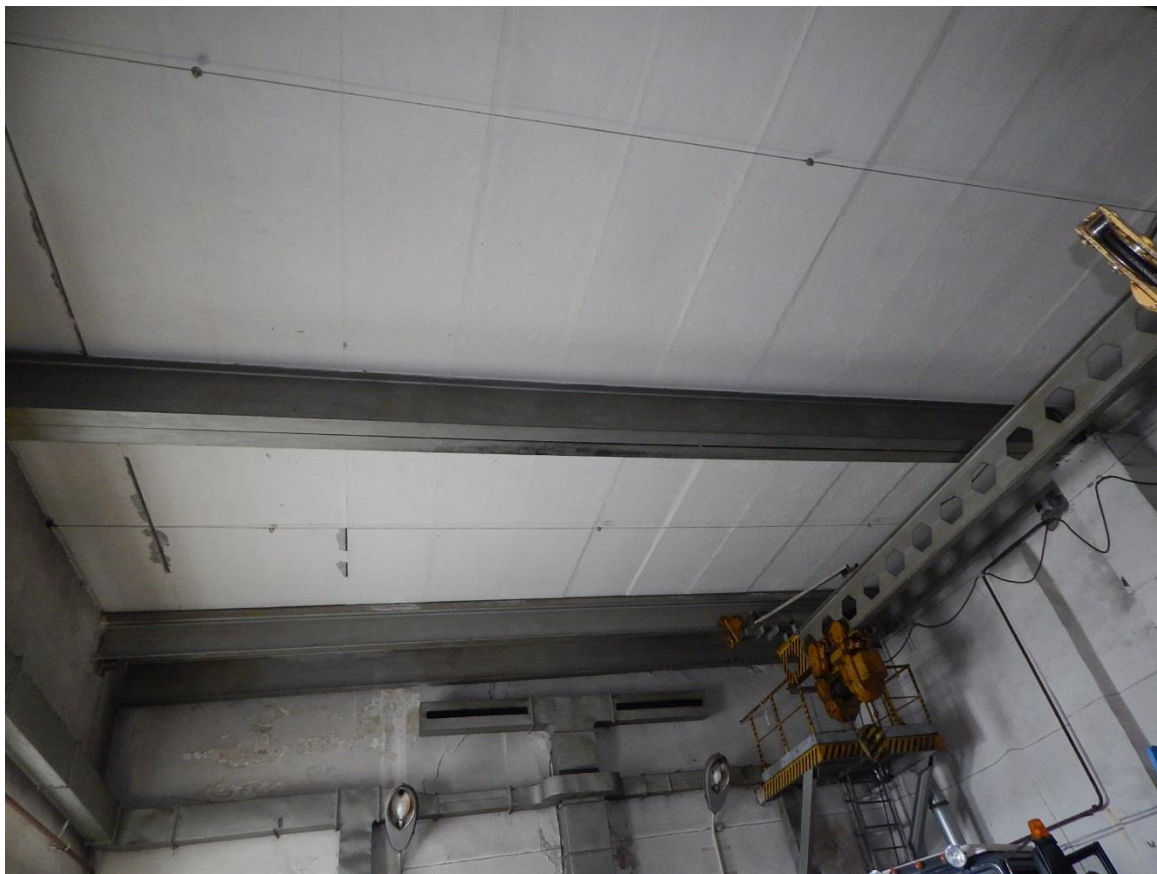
Внешний вид плит покрытия в помещении гаража
